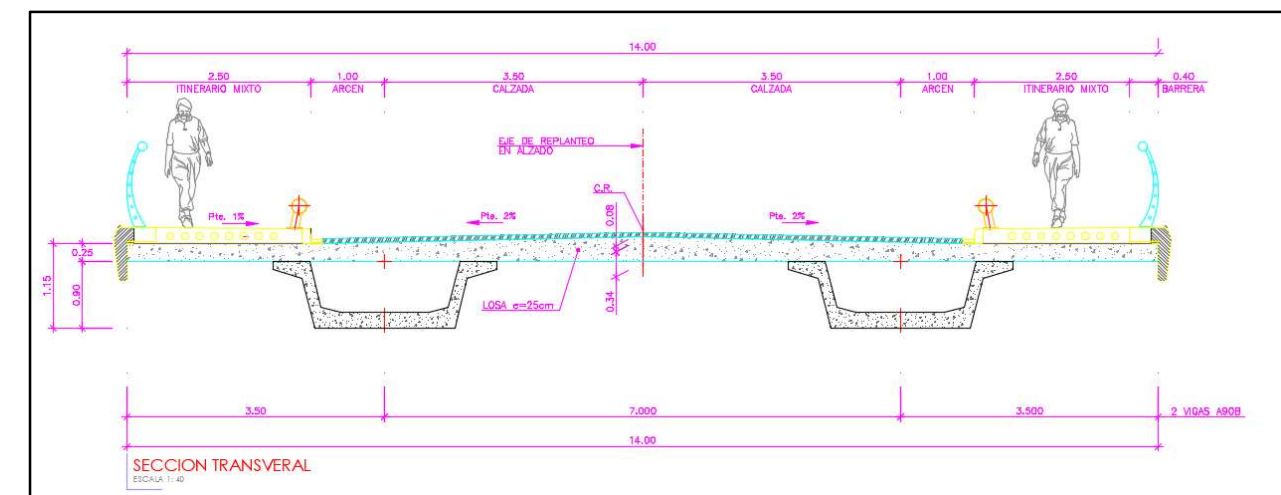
Sección transversal tablero: vigas + losa superior.
